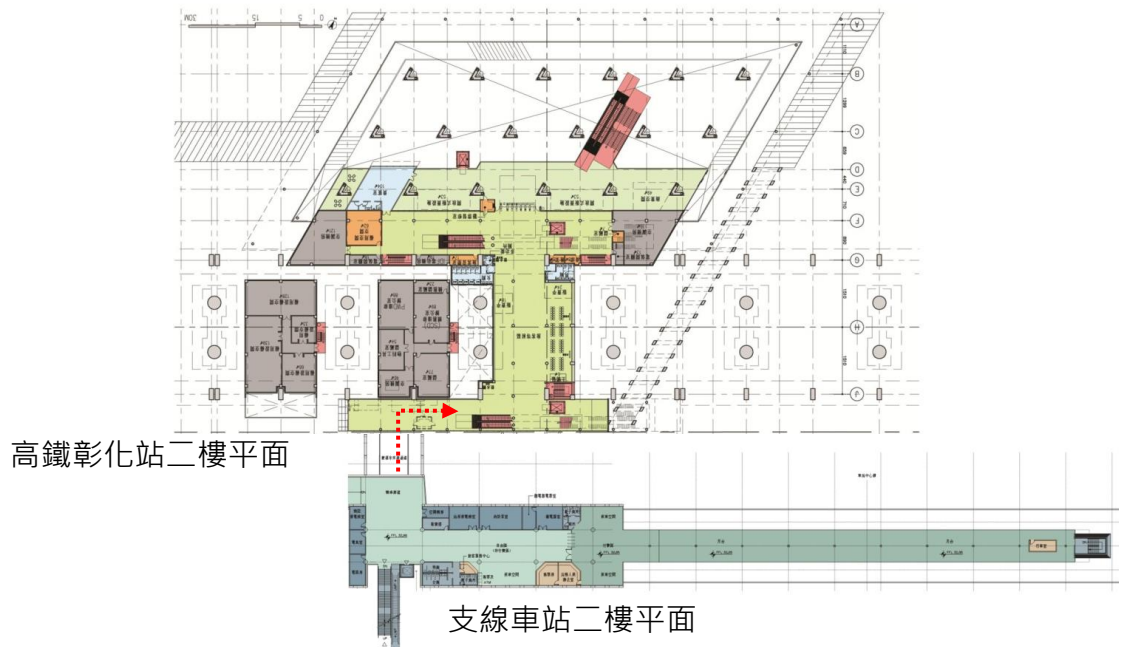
車站二樓銜接平面配置建議示意圖
